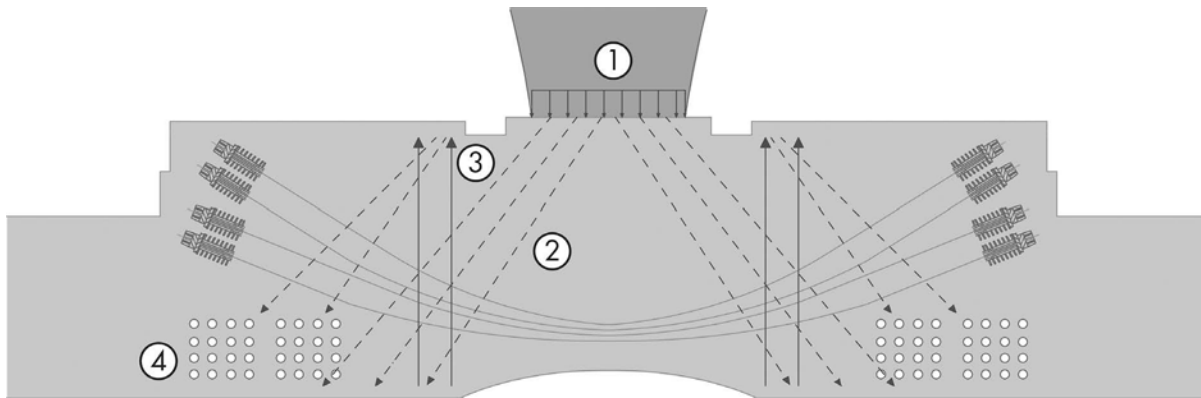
Lastabtrag Fachwerk: 1 Kelchlast, 2 Druckstrebe, 3 Zugstrebe (Auffhängebewehrung), 4 Längsspannglieder
